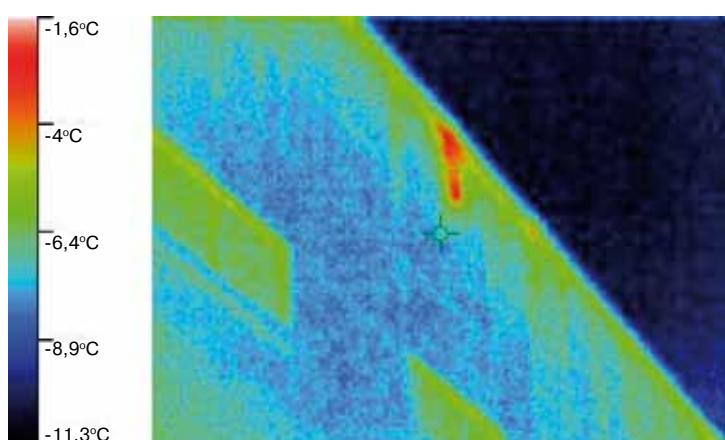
Образование наледи на наружной поверхности вентилируемого фасада здания бассейна из-за неудовлетворительного технического состояния пароизоляции стены
